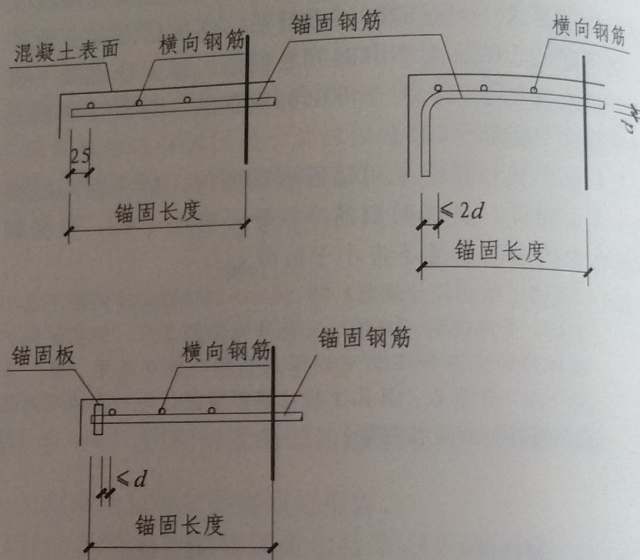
纵向受拉钢筋锚固长度范围内横向钢筋示意图
